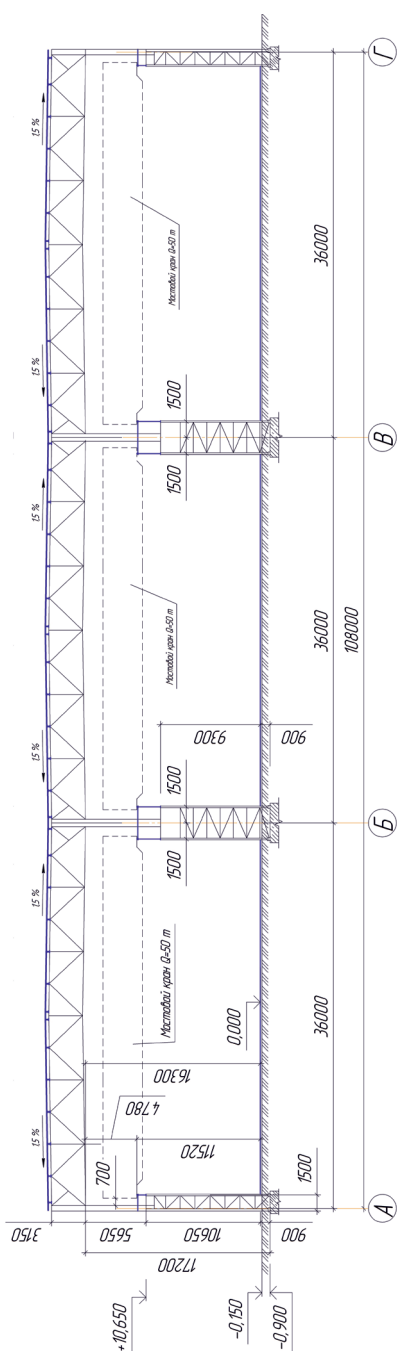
Поперечный разрез трехпролетного промздания, оборудованного мостовыми кранами
